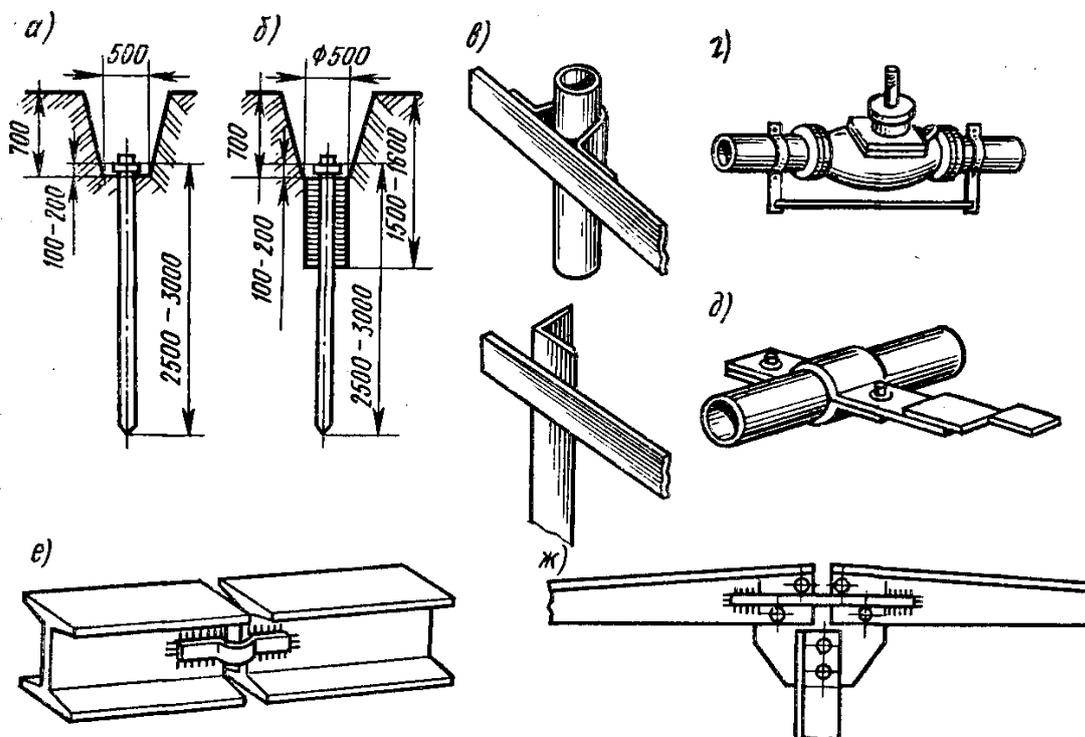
Устройство заземления: *а* - в грунте, не требующем специальной обработки; *б* - в грунте, требующем искусственного повышения проводимости; *в* - соединение заземлителей с полосовой сталью; *г* - устройство перемычки; *д* - присоединение стальной полосы к трубе на хомуте; *е* - на стыке двух балок сваркой; *ж* - то же, болтами
